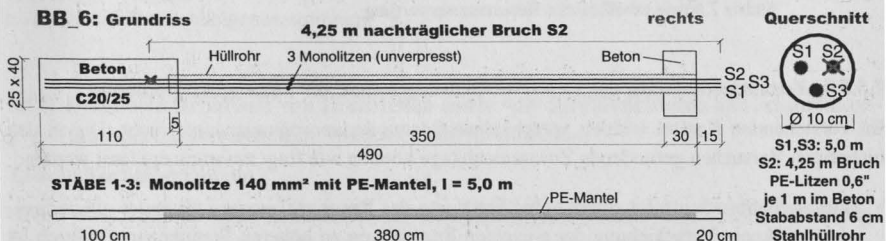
Versuch BB_6: Grundriss und Querschnitt des Versuchskörpers „Erdanker“
